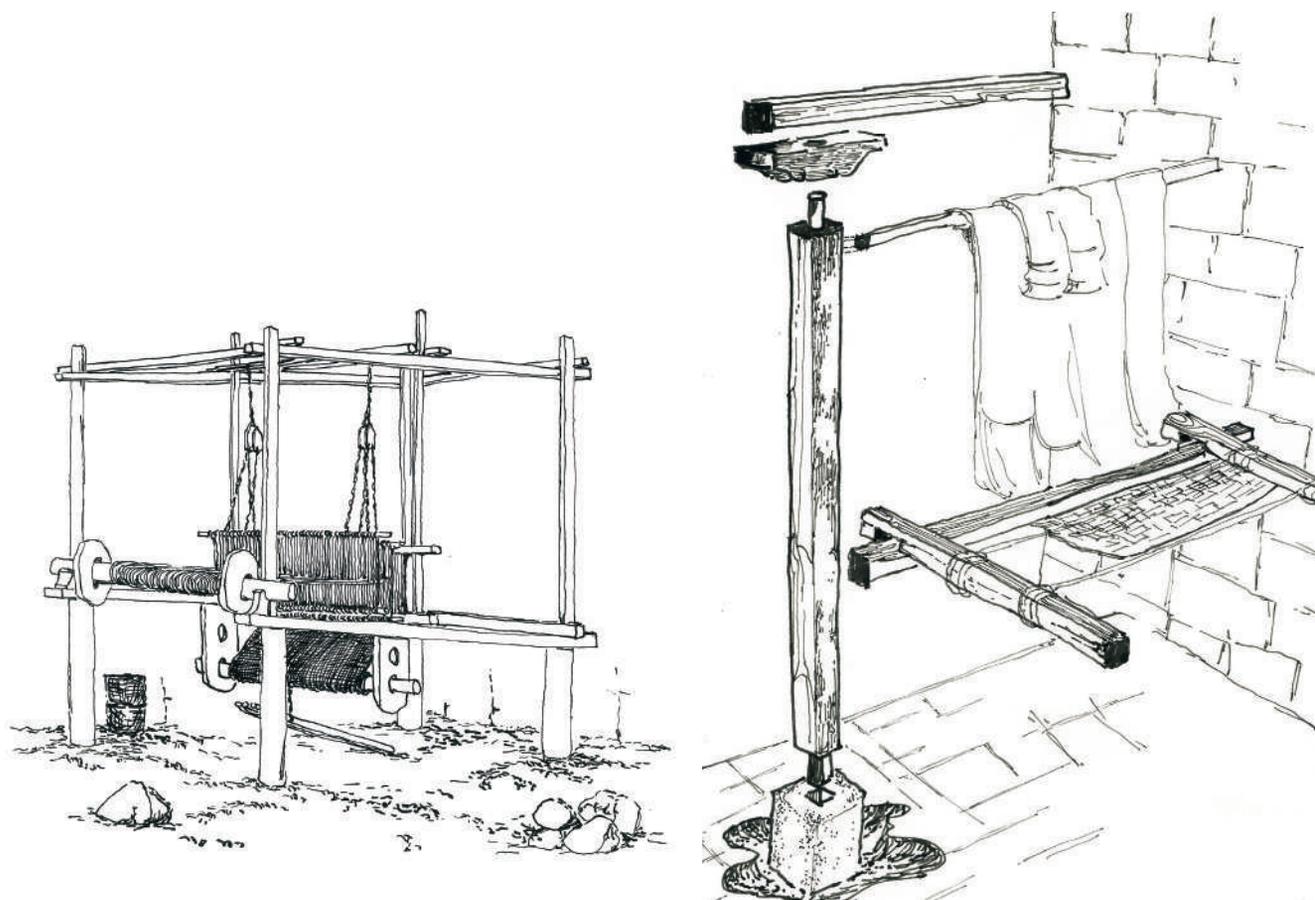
Instrumentos artesanales vinculados a la estructura de la vivienda.
